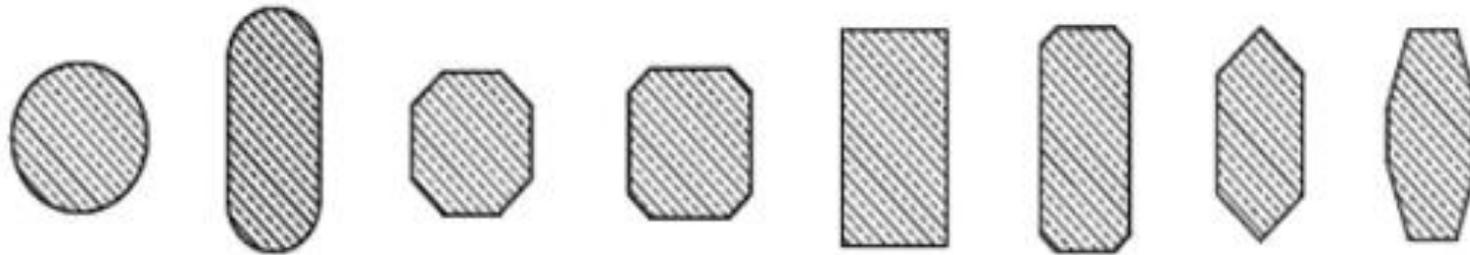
Algunos tipos de sección transversal de columnas en puentes
